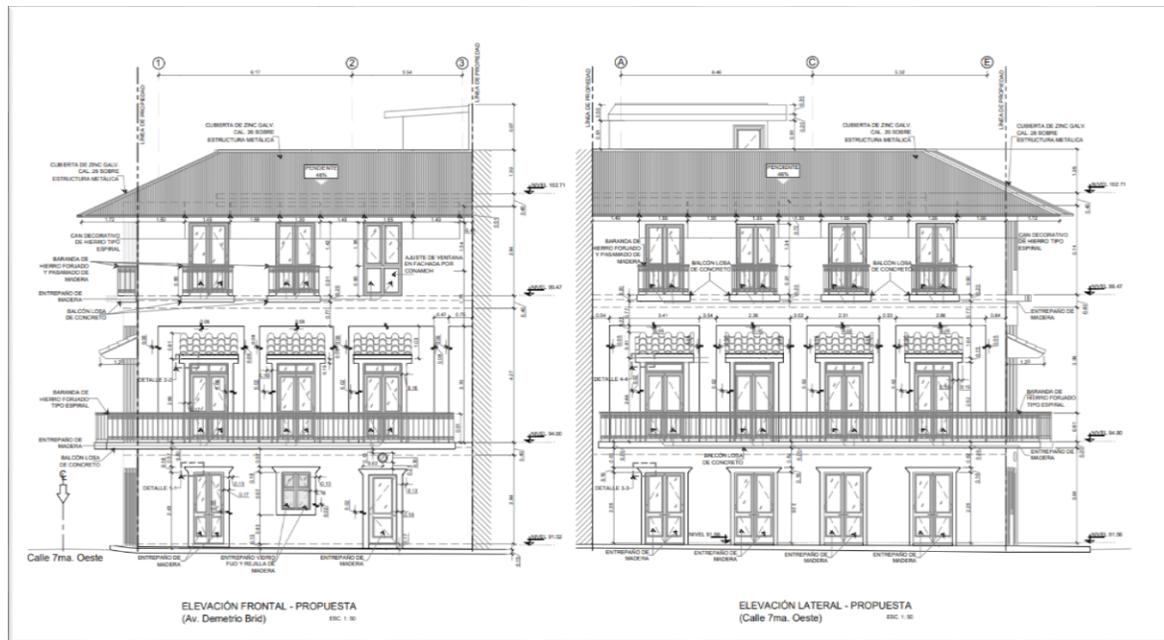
Plano de elevación frontal y lateral propuesta.
